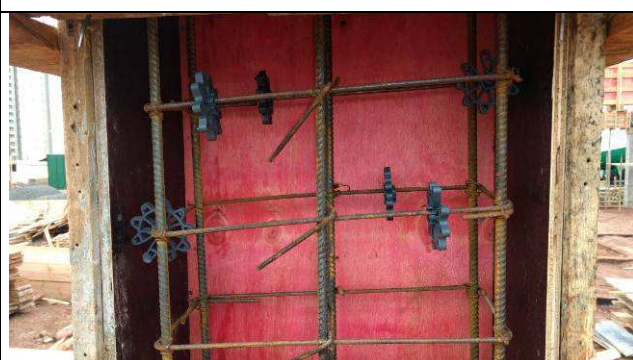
C: Formas e armaduras do pilar P33 do prédio principal.
